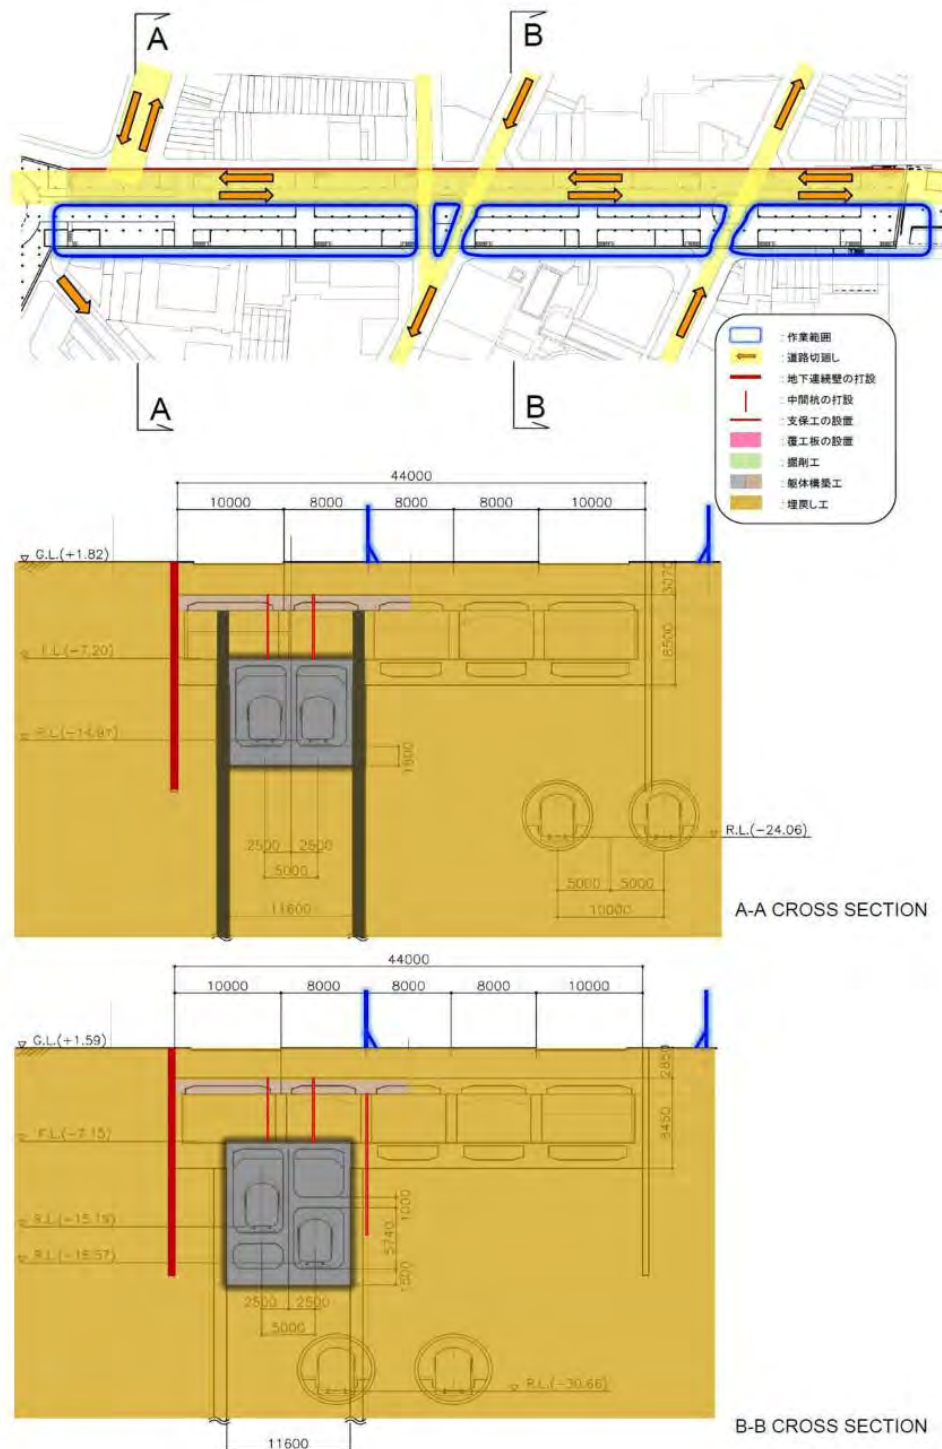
レロイ通り地区の都市鉄道 1 号線と地下街の施工手順図 (その 10/14)
